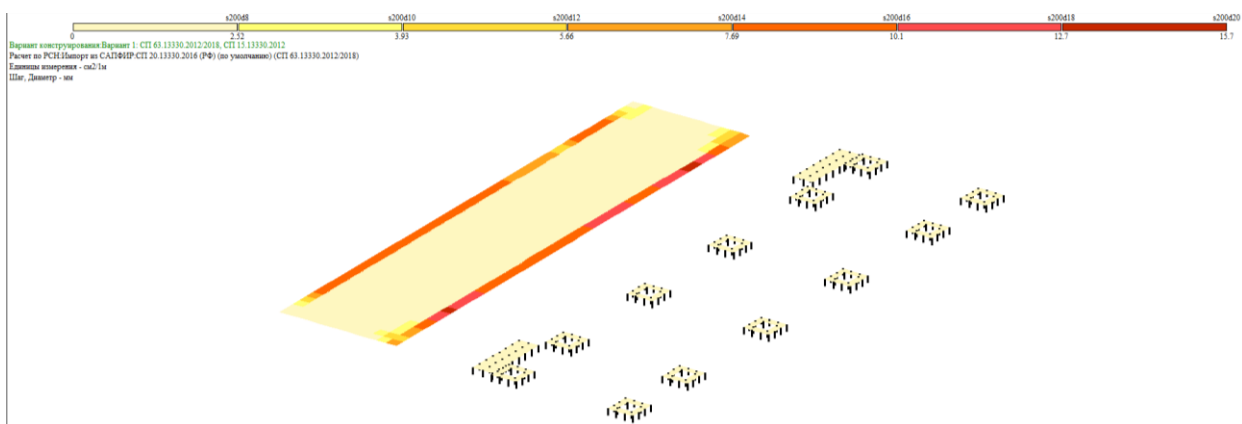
Схема армирования низа плиты по оси ОУ
